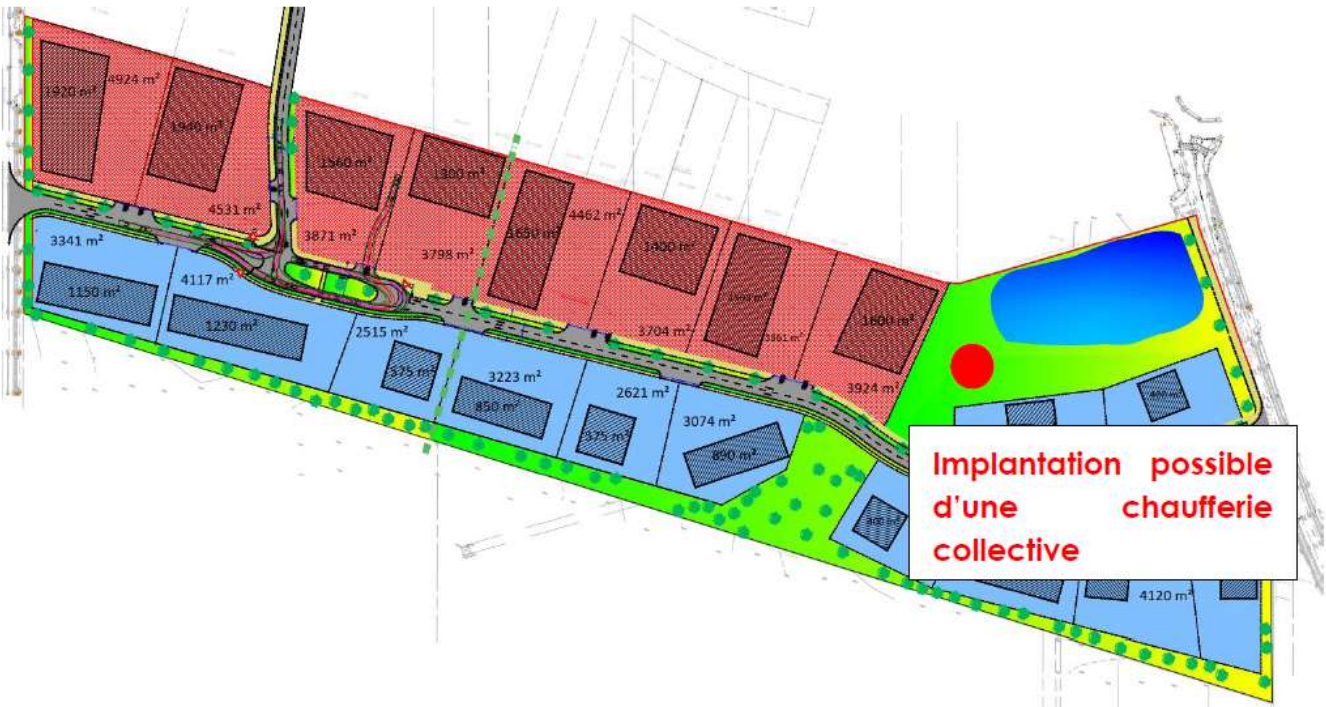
Implantation possible d'une chaufferie collective (Source : Otelio – décembre 2021)
